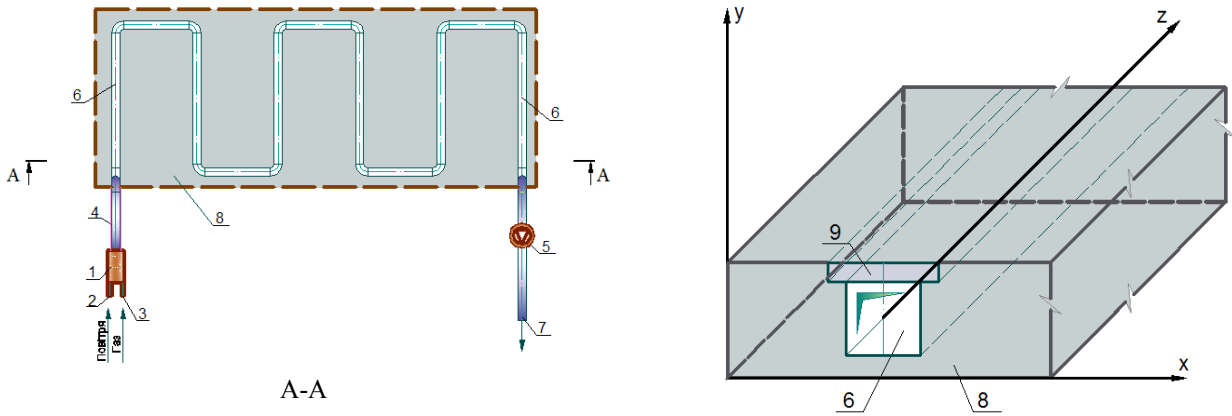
Автономна система теплопостачання з трубчастими газовими нагрівачами, розташованими у будівельних конструкціях /Autonomous heat supply system with tube gas heaters located in building structures:
